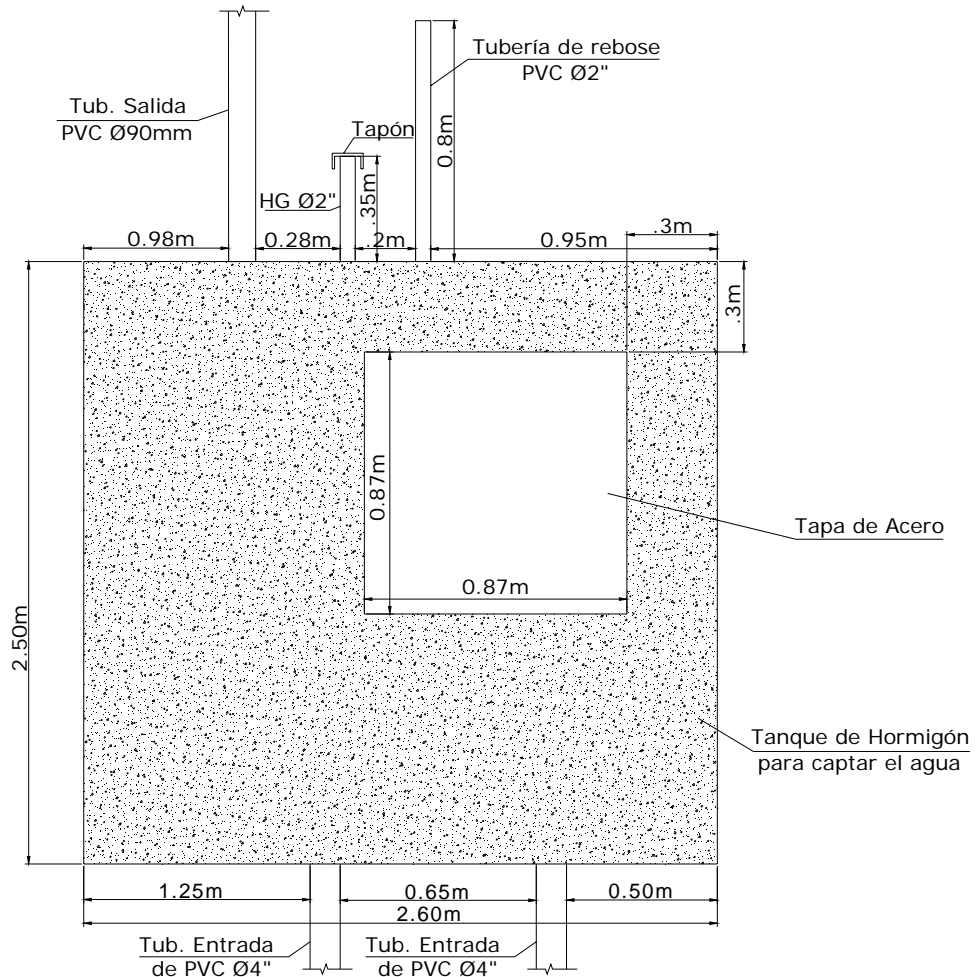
Vista en planta del tanque de presión de la captación 1.
